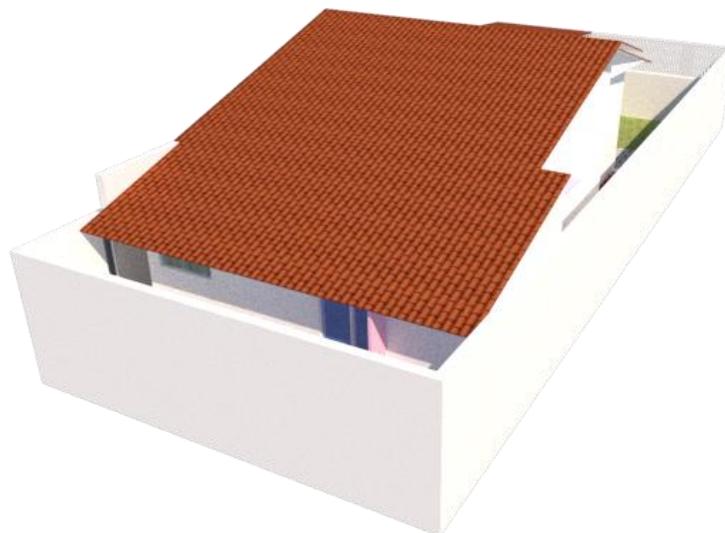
Proposta espelhada orientada à Sudeste - Fachada posterior
